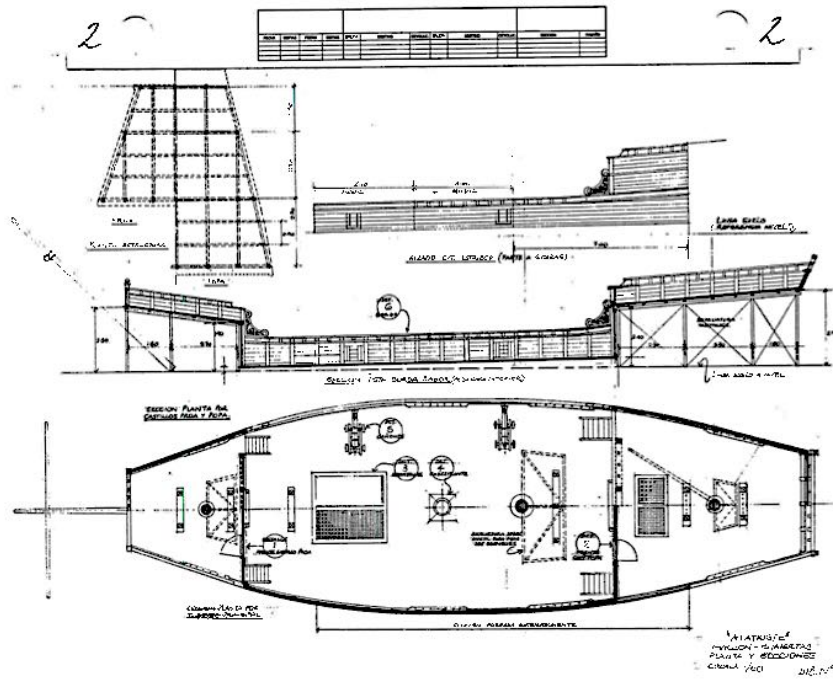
Plano. Galeón cubierta. Planta y secciones. *Alatraste*.
